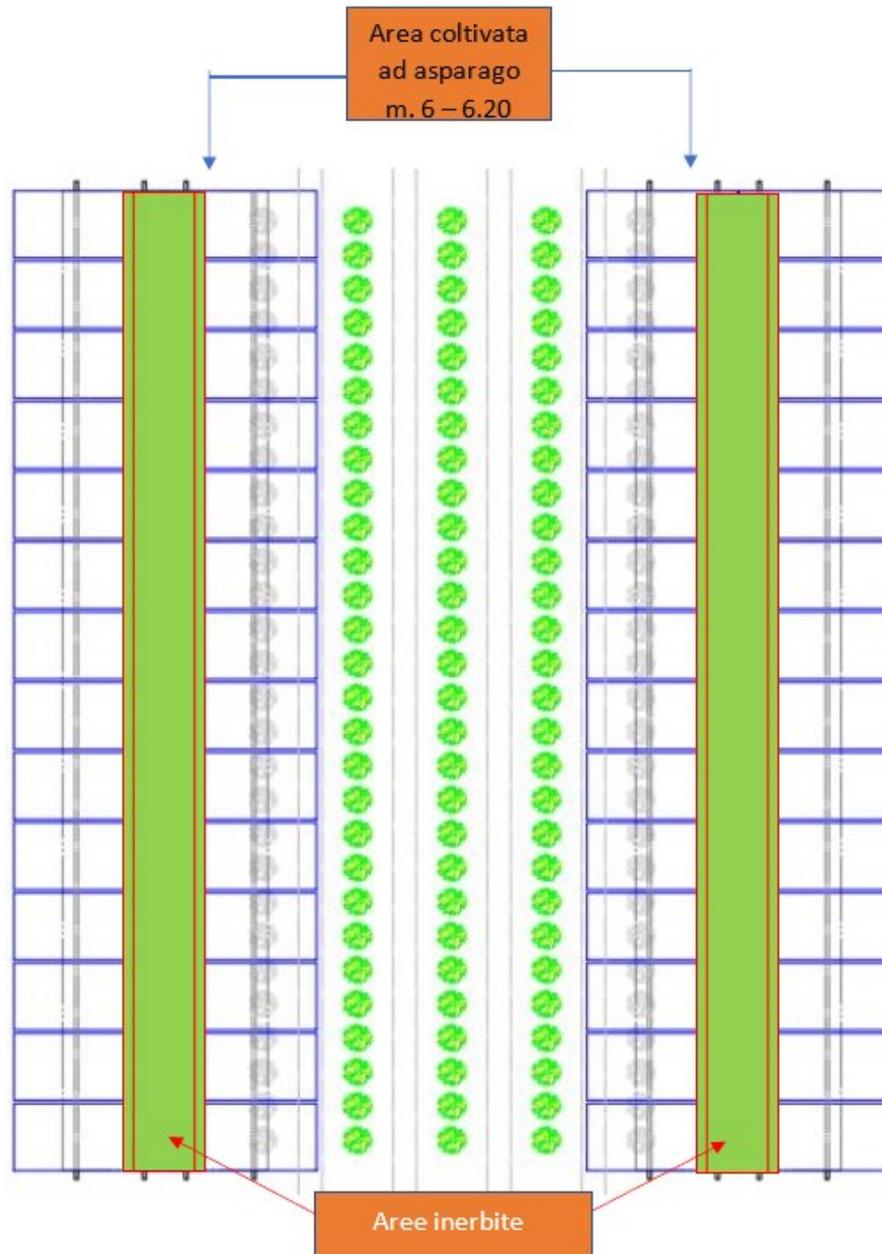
Piantazione di asparago tra le file di tracher – vista dall’alto (5 file) con l’inerbimento
